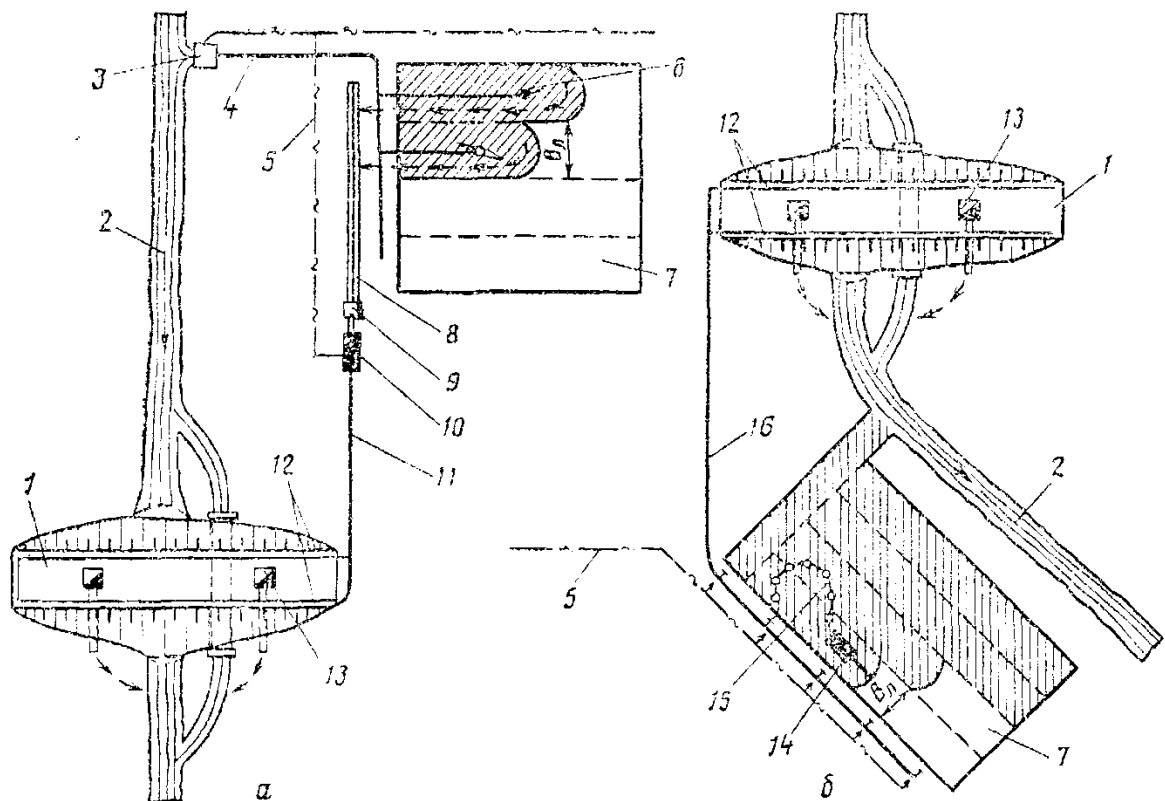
Технологические схемы производства земляных работ способом гидромеханизации: а — размывом струей воды (гидромониторный способ); б — засасыванием грунта из-под воды (рефулерный способ); 1 - место укладки грунта; 2 - река; 3 - насосная установка; 4 - напорный водовод; 5 - ЛЭИ; 6 - гидромонитор; 7 - карьер; 8 - канава для сбора пульпы; 9 - приямок (зумпф); 10 - землесосная установка; 11 - напорный пульповод; 12 - распределительный пульповод; 13 - сбросные колодцы; 14 - земснаряд; 15 - плавучий пульповод; 16 - магистральный пульповод.
